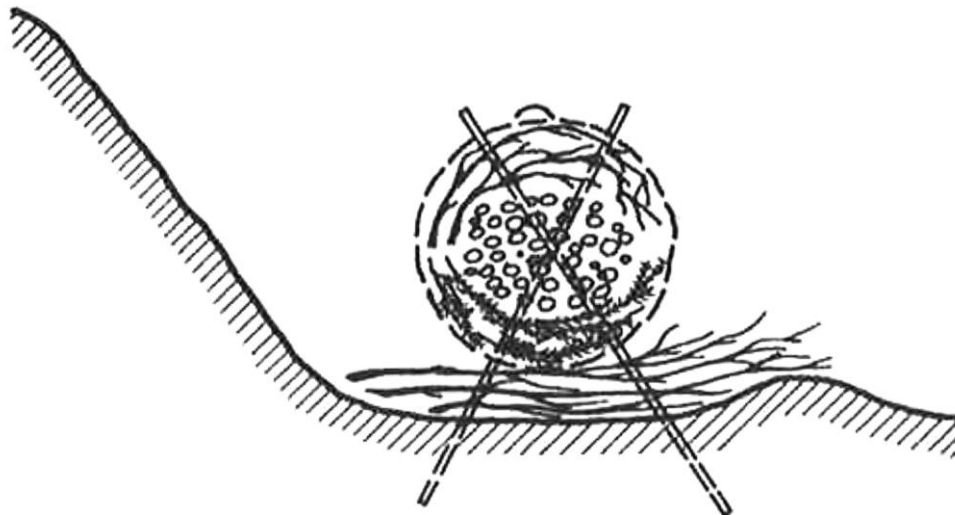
Walze formen (Bauvorgang 4, Faschinenwalze)
